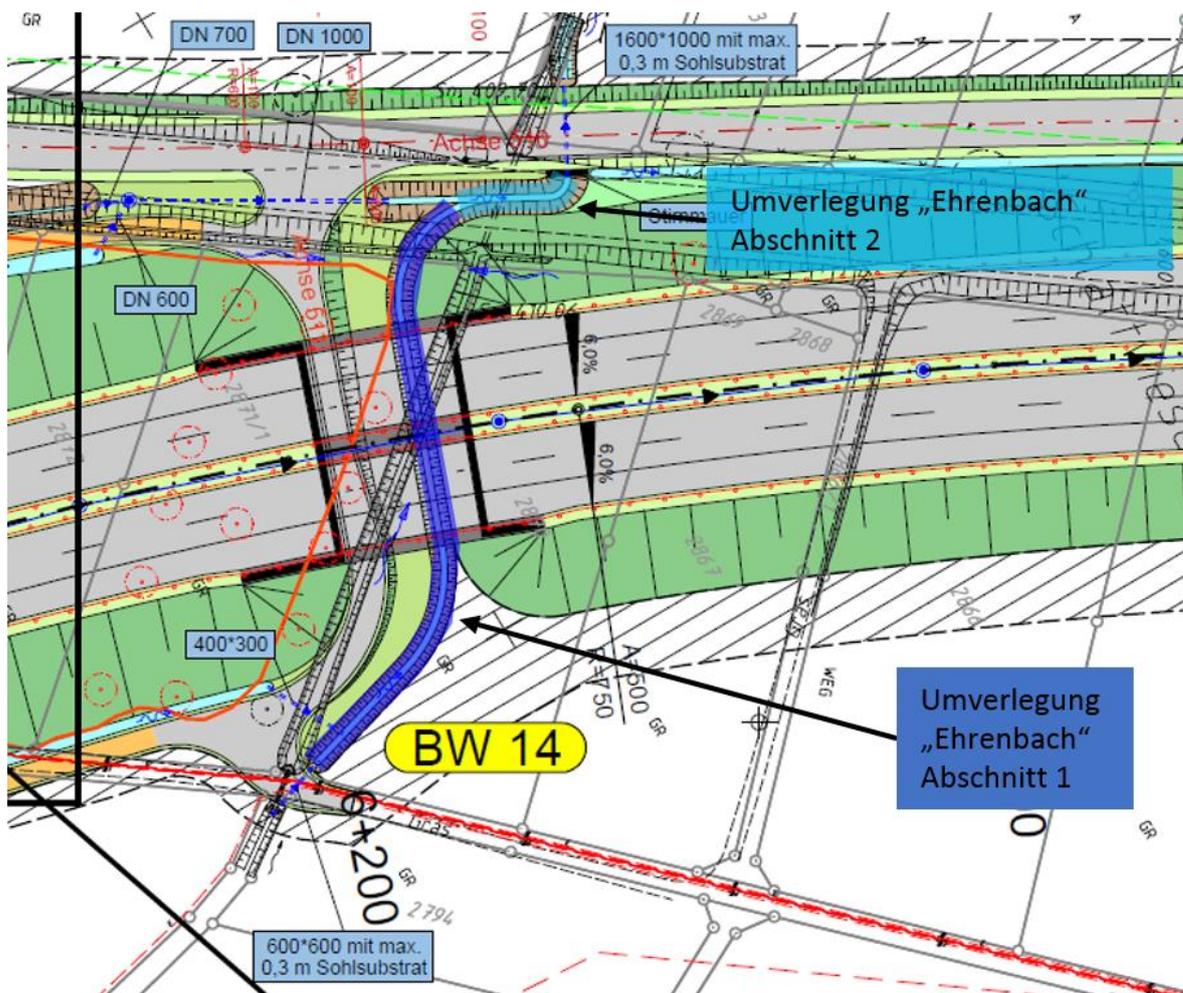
Lageplan zur Verlegung des Ehrenbachs und den Durchlassdimensionierungen
